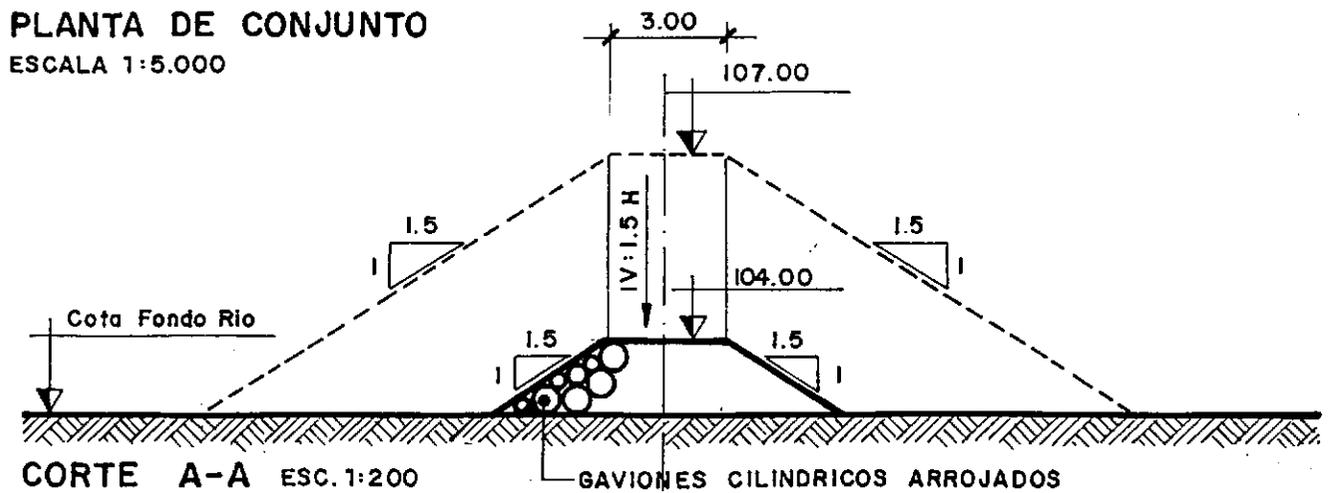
ALTERNATIVA 1 VARIANTE A
